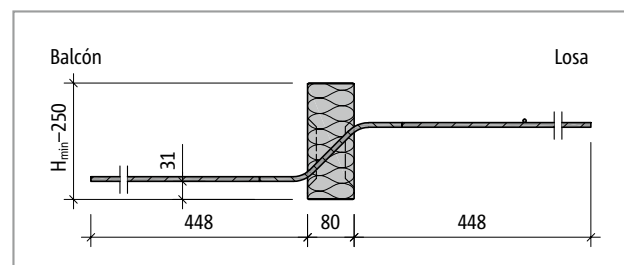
Schöck Isokorb® T tipo Q-Z-V6 en R0: Sección del producto
